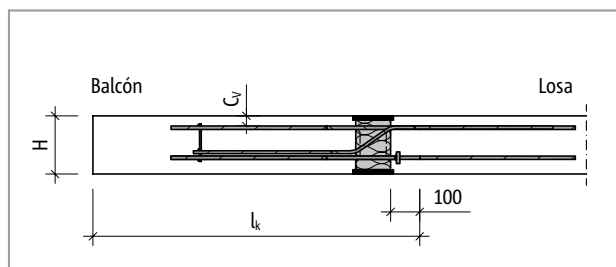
Schöck Isokorb® XT tipo C: Sistema estático
